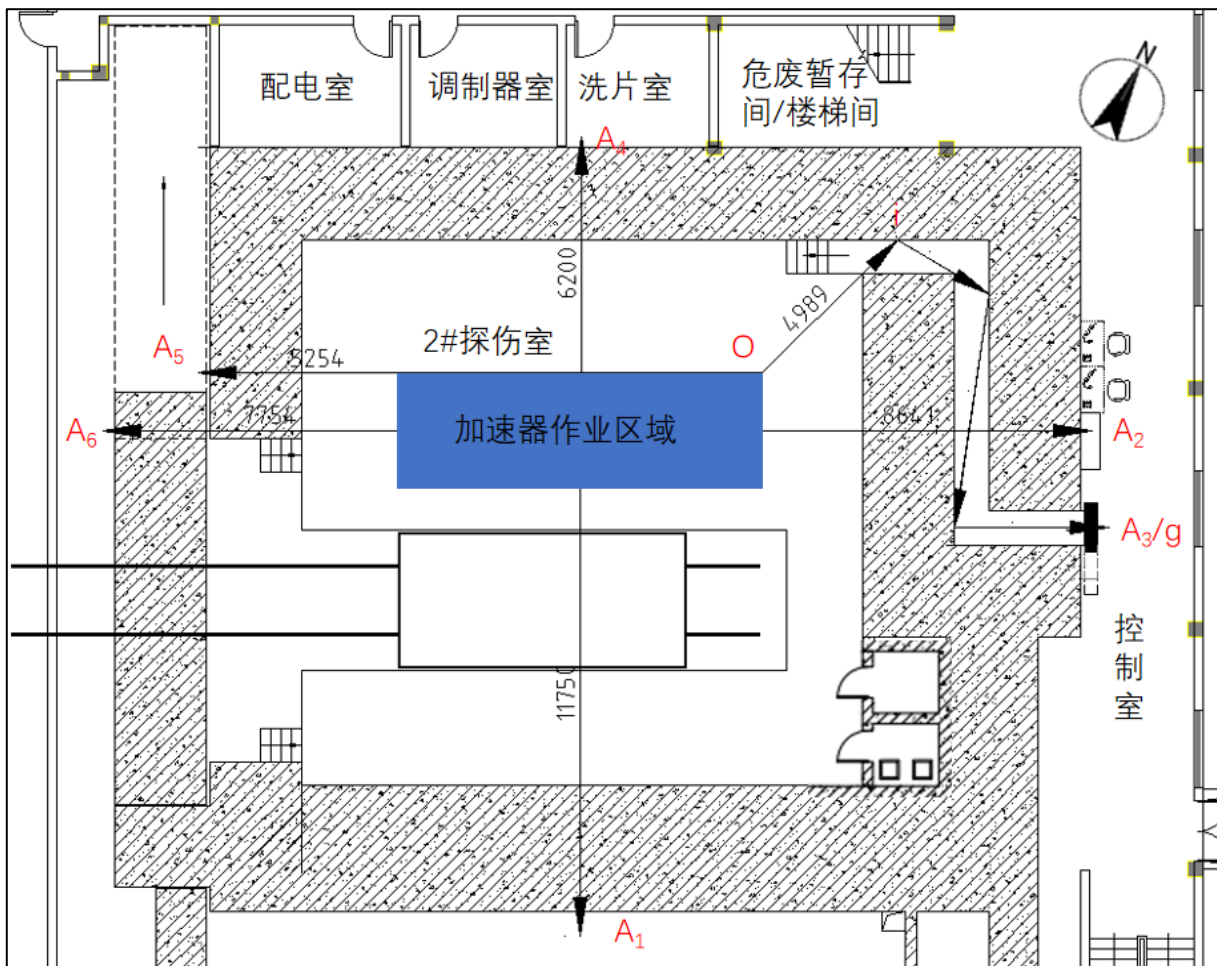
电子直线加速器预测点位平面示意图（单位：mm）
